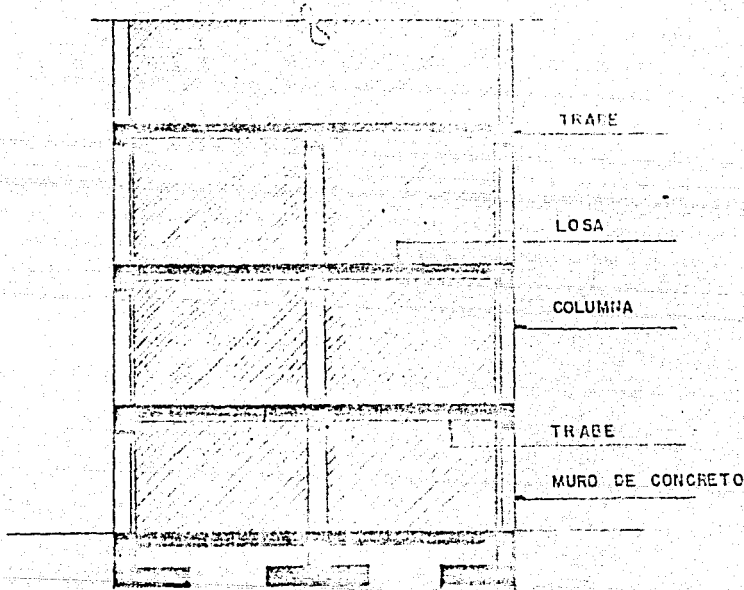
Estructura esquelética con losa maciza y elementos rigidizantes. Tomado de Del Valle, C., Enrique "Comportamiento de las Estructuras", Revista Mexicana de la Construcción No. 374 p. 38.
